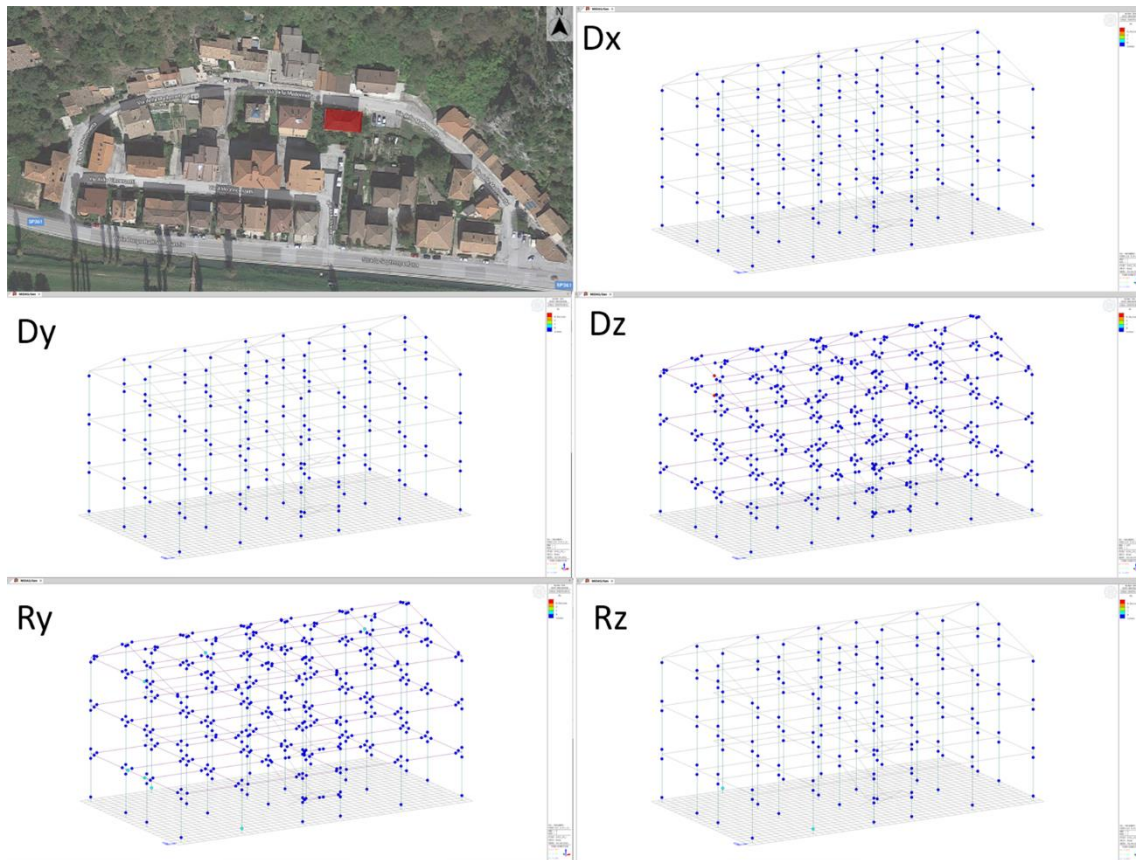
Cedimento fondale applicato ad un edificio in c.a a tre piani con platea di fondazione nella POSIZIONE 3 all'interno del quartiere "Madonnetta" del comune di Pioraco.
